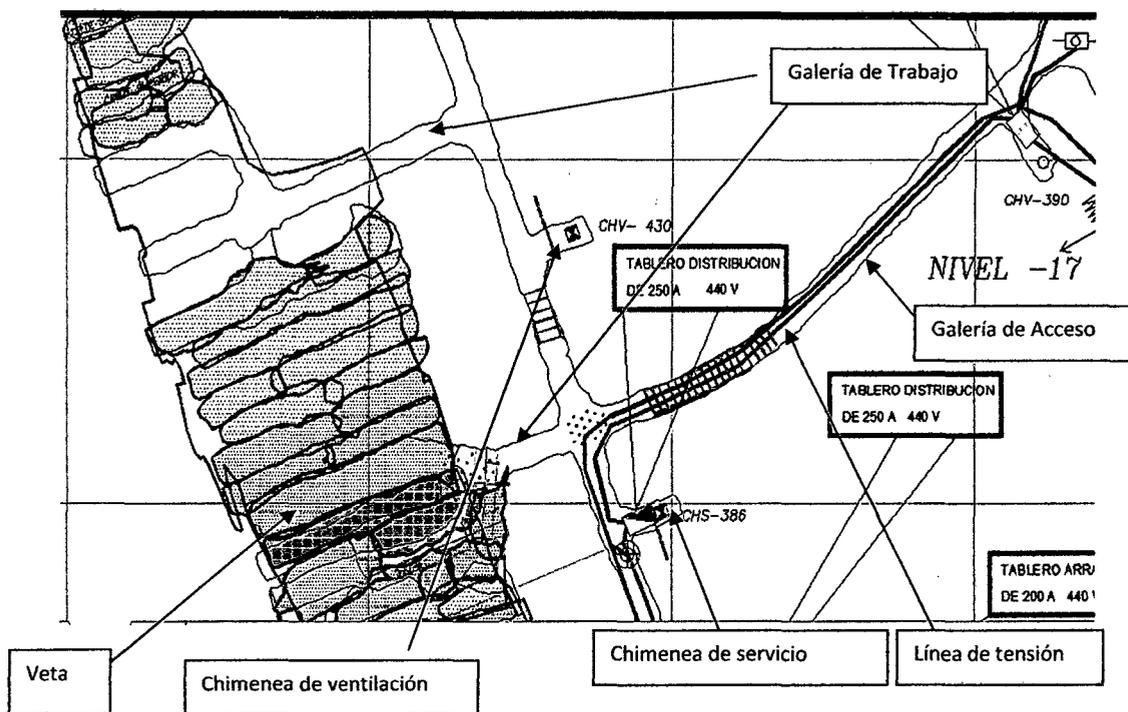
Detalles de ruta en niveles mina Limpe Centro
